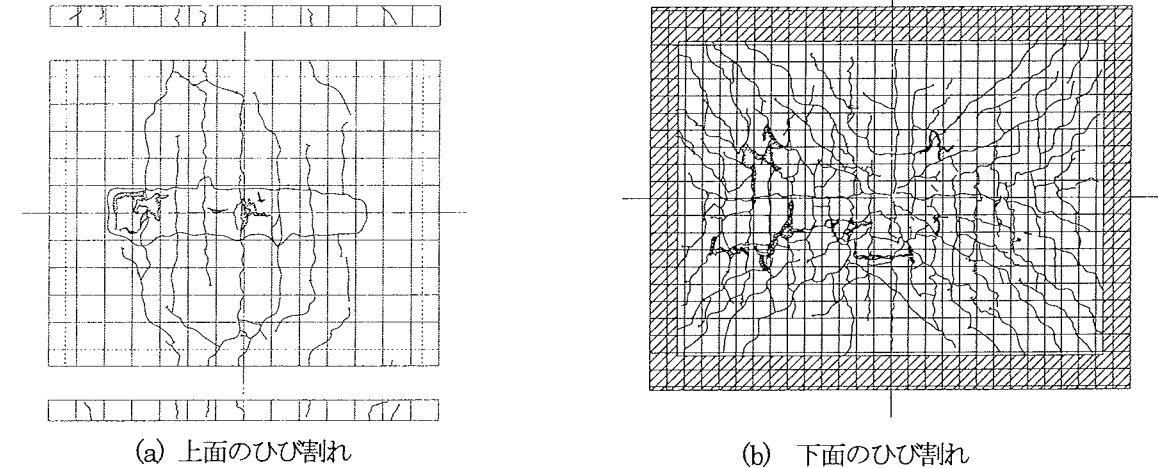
No. S39-19-1 供試体下面の試験後ひび割れ状況
